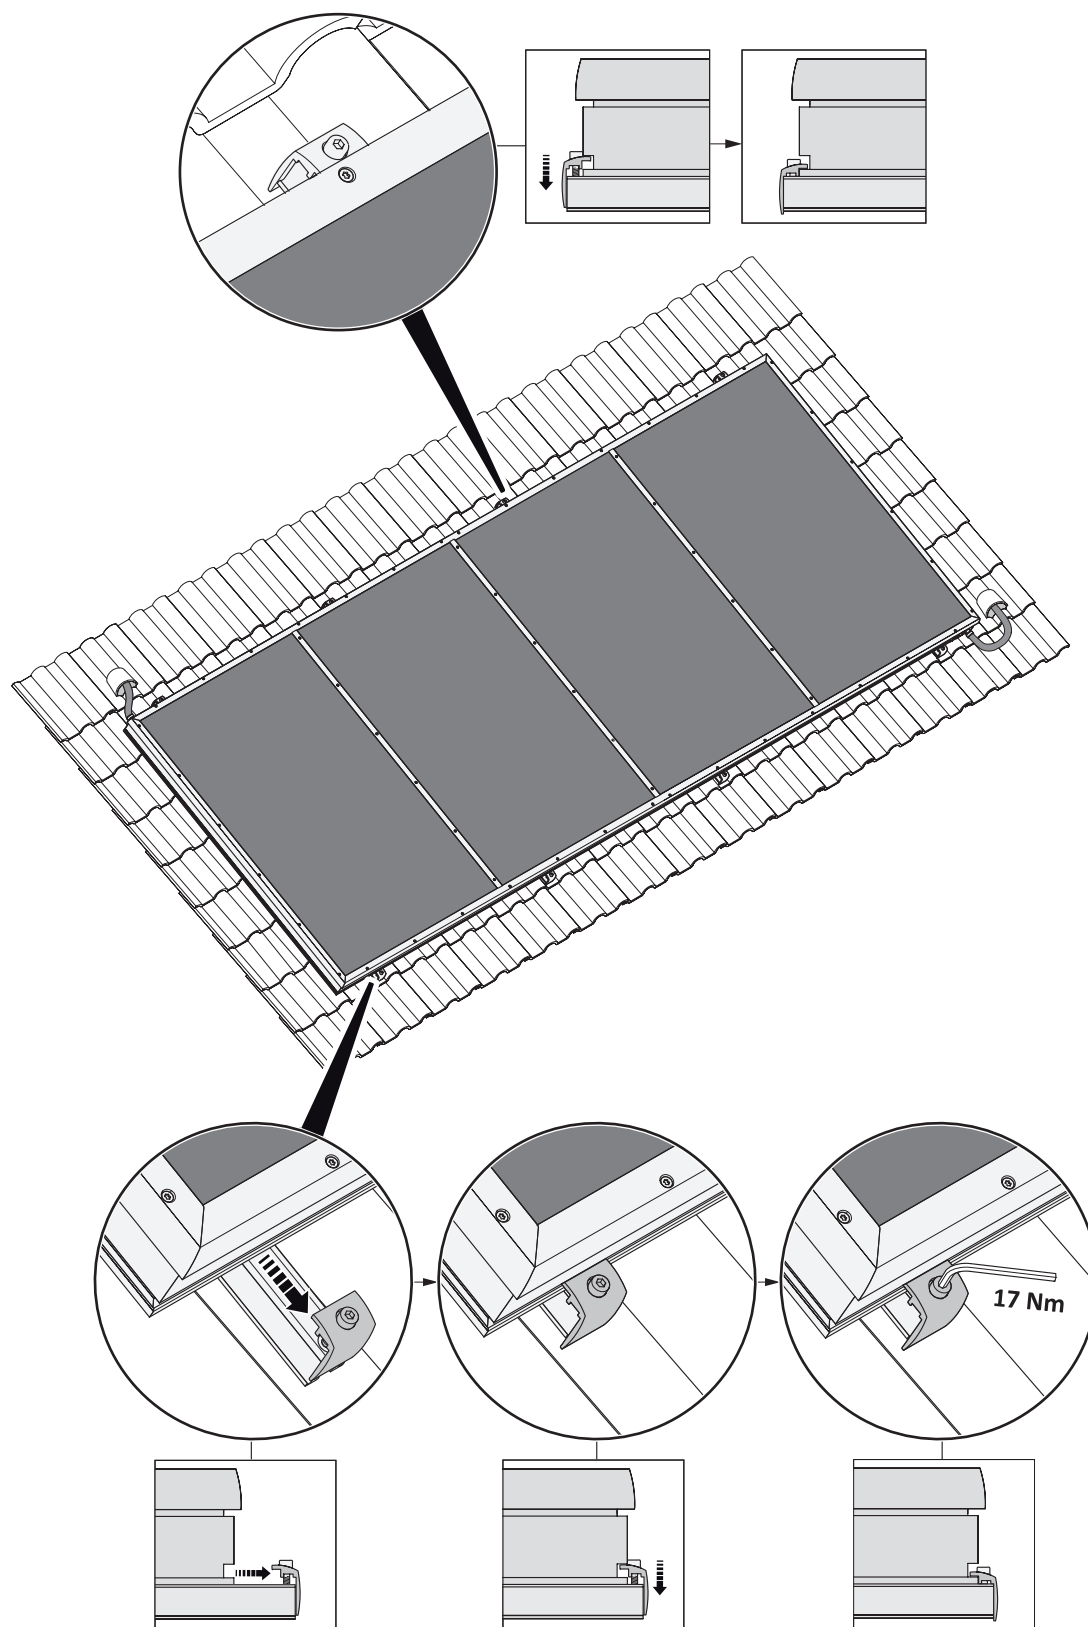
Fissaggio di un collettore alle guide di bloccaggio
